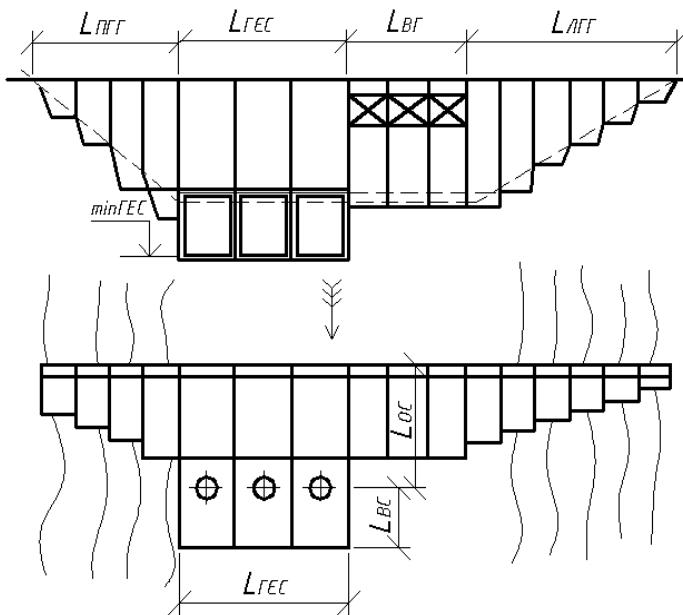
Вид з нижнього б'єфу і план гідровузла
